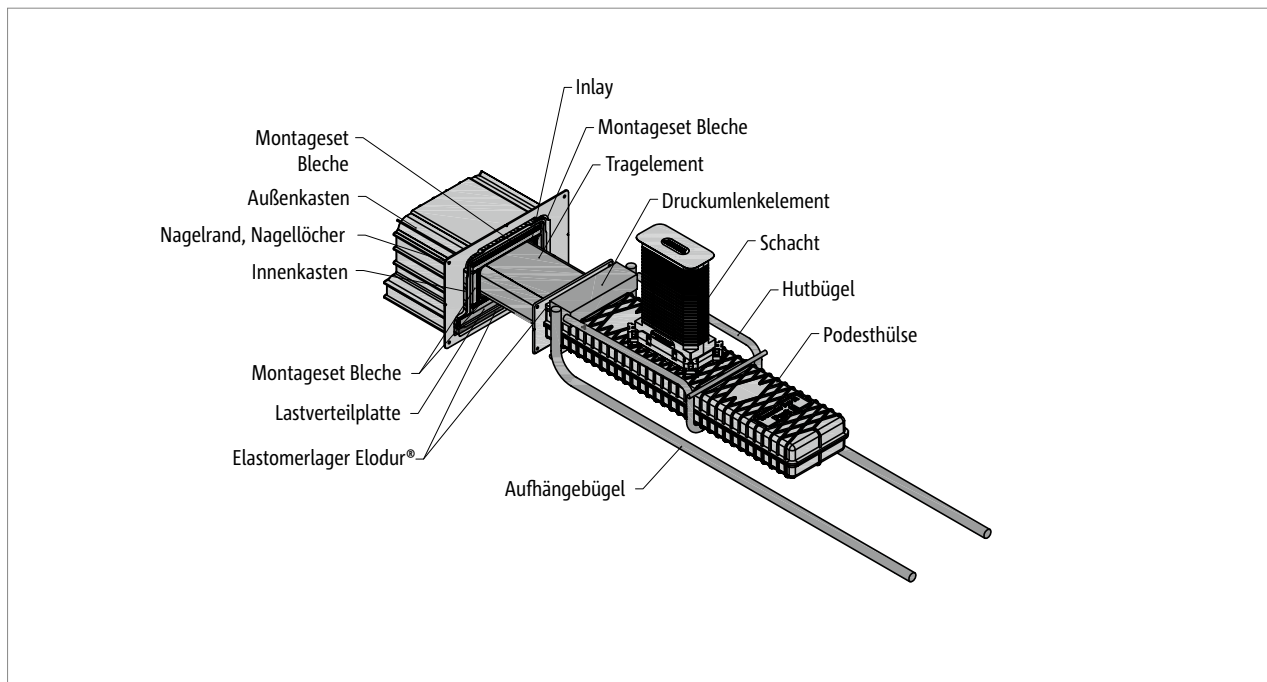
Tronsole® M: Wandelement, Tragelement und Podesthülse mit detaillierter Benennung wichtiger Bestandteile
